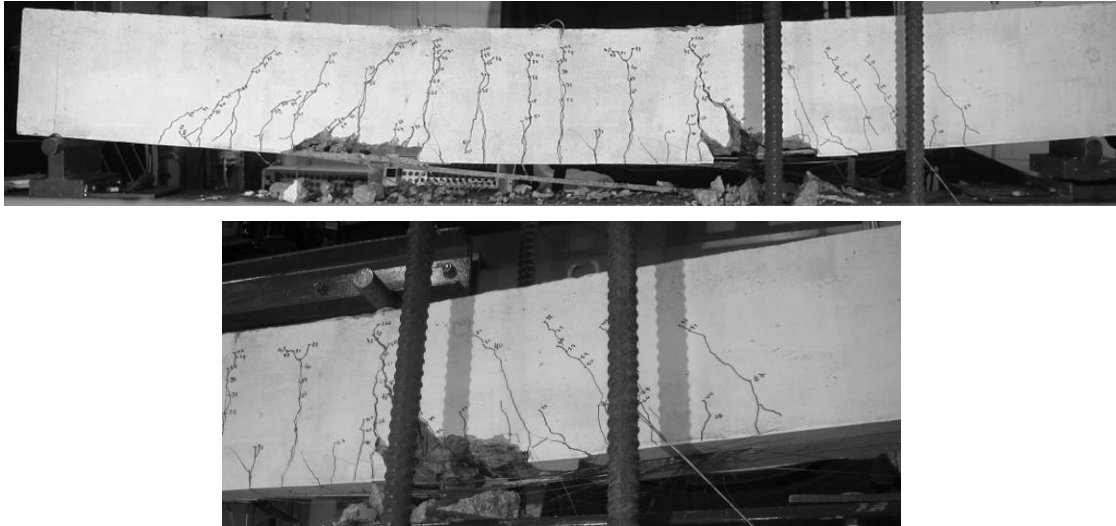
Pormenor do modo de rotura da viga S2-PC1 (rotura do laminado de CFRP).
